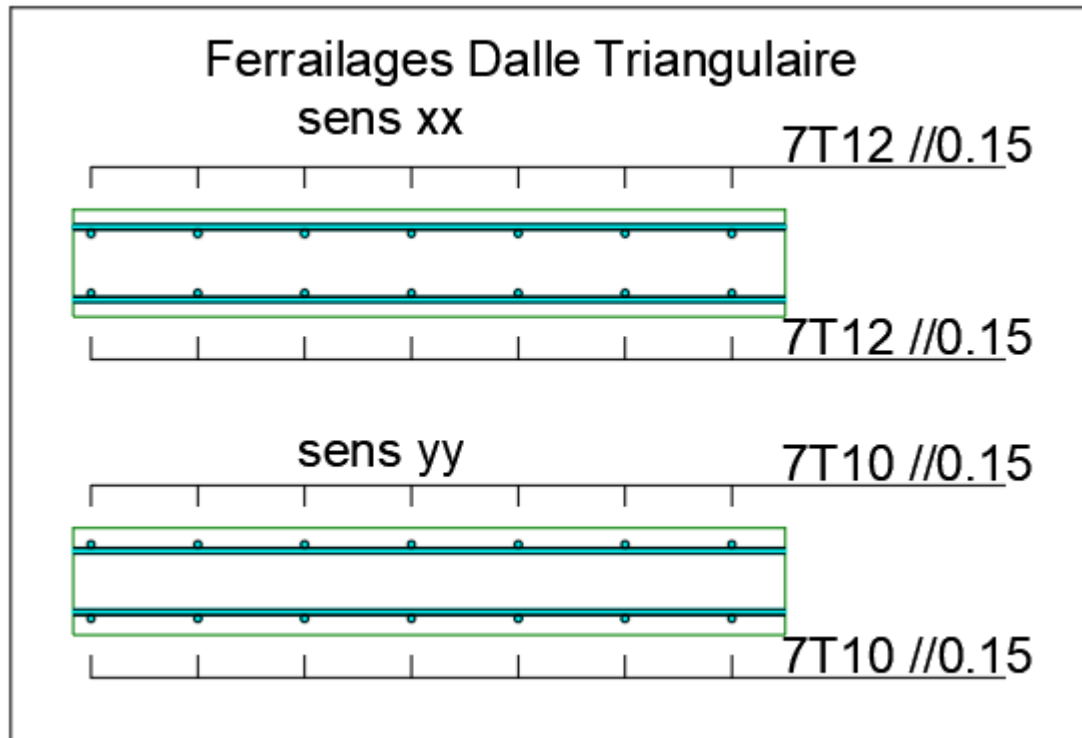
Plan de ferrailage de la dalle triangulaire.
